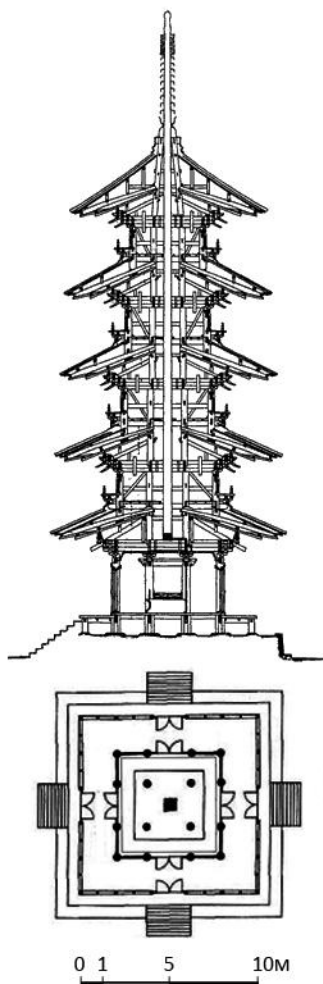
Pianta e sezione della pagoda di Gojunoto, Giappone
